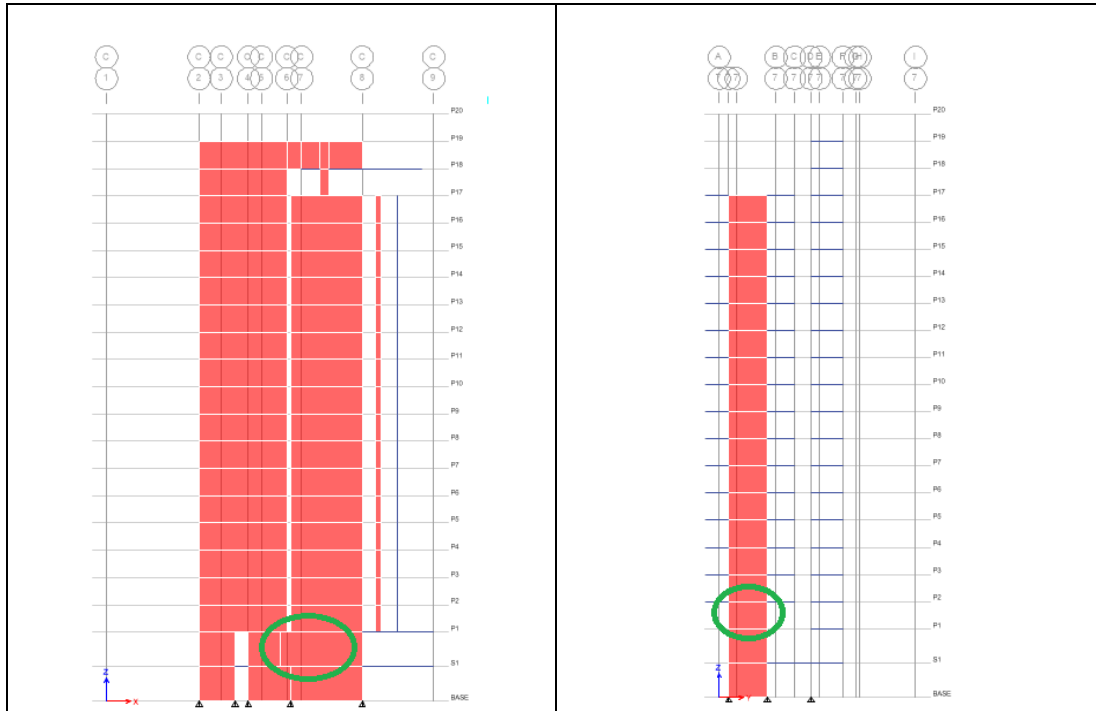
Edificio M7, planta piso 2, se indica el elemento dañado
